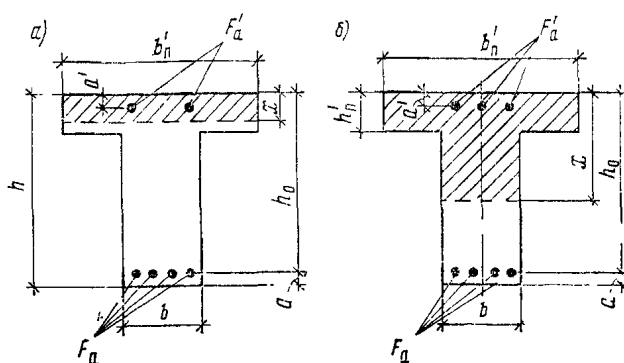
Форма сжатой зоны в сечении изгибаемого железобетонного элемента с полкой в сжатой зоне а — при расположении границы сжатой зоны в полке; б — то же, в ребре
